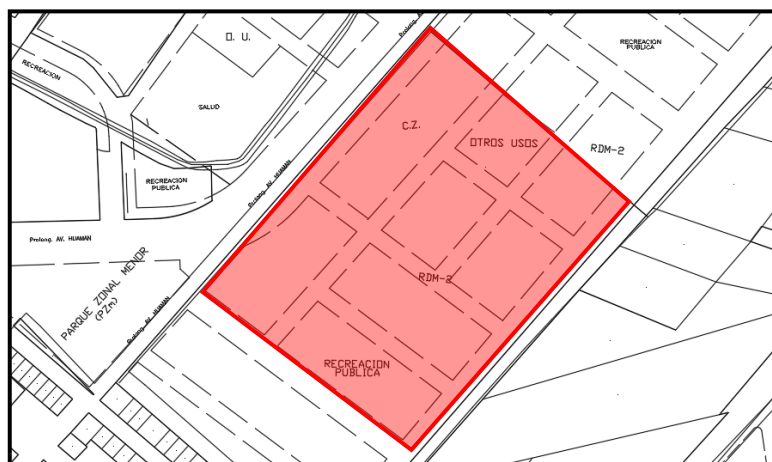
Plano Terreno 04 Fuente: Elaboración Propia
